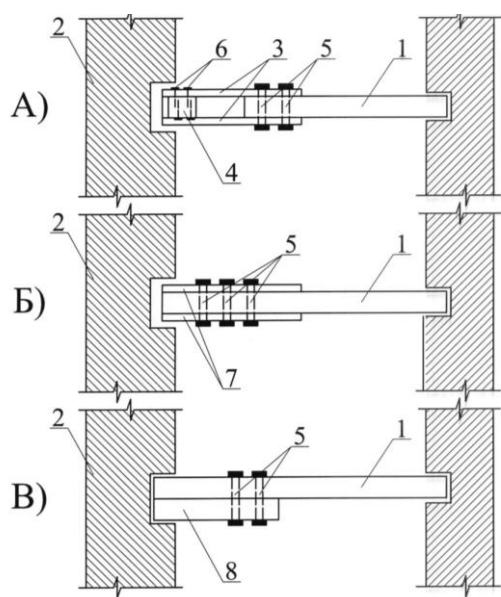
Усиление деревянных балок: А – деревянными протезами (вид сверху); Б – боковыми накладками (вид сверху); В – подбалкой (вид сбоку); 1 – балка; 2 – стена; 3 - деревянный протез; 4 – прокладка; 5 – болты; 6 – гвозди; 7 - боковые накладки; 8 - подбалка
